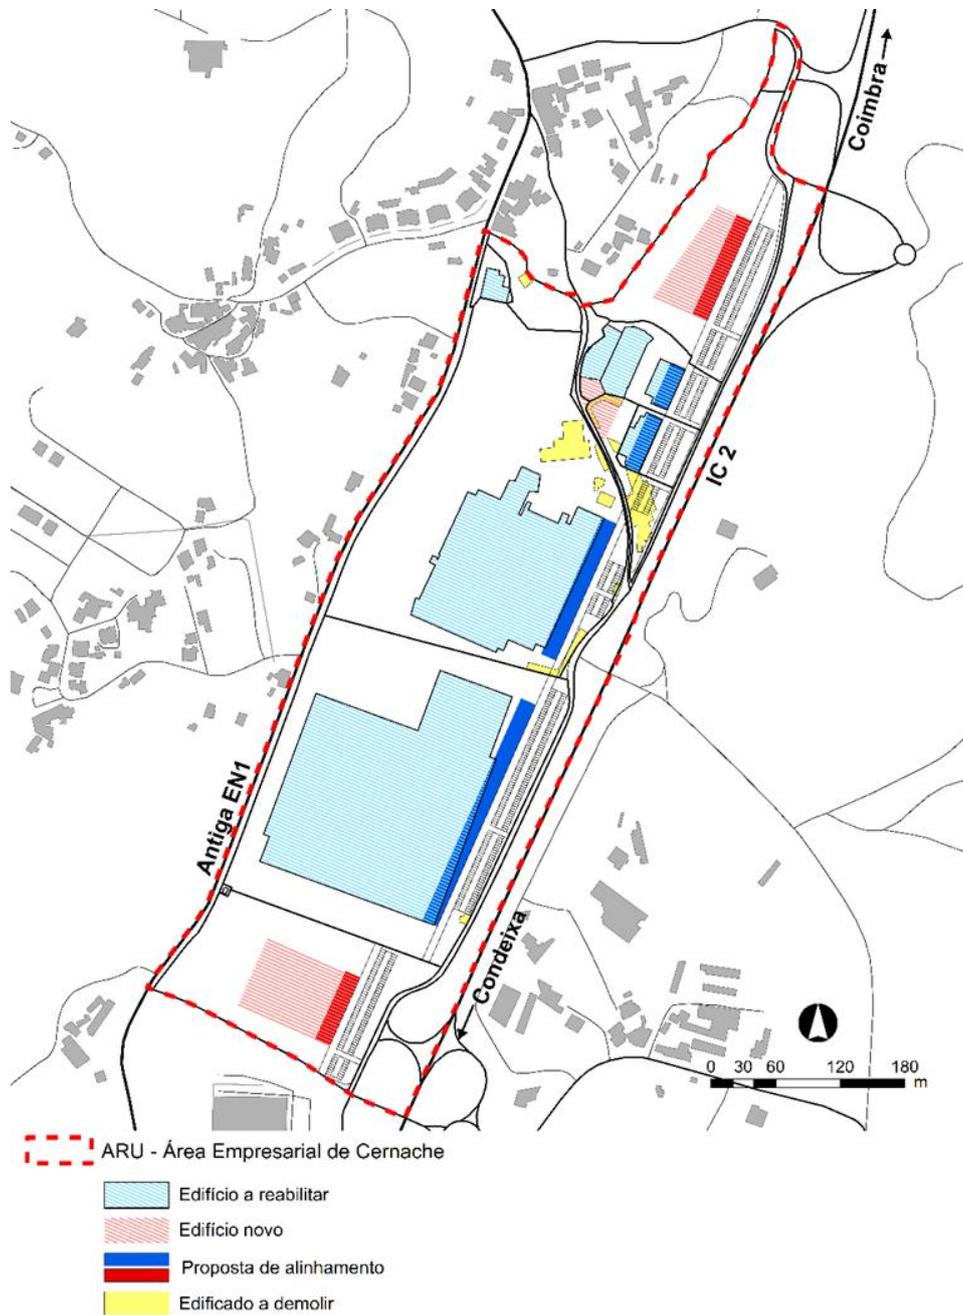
Orientações para a intervenção no espaço privado (edificado)
